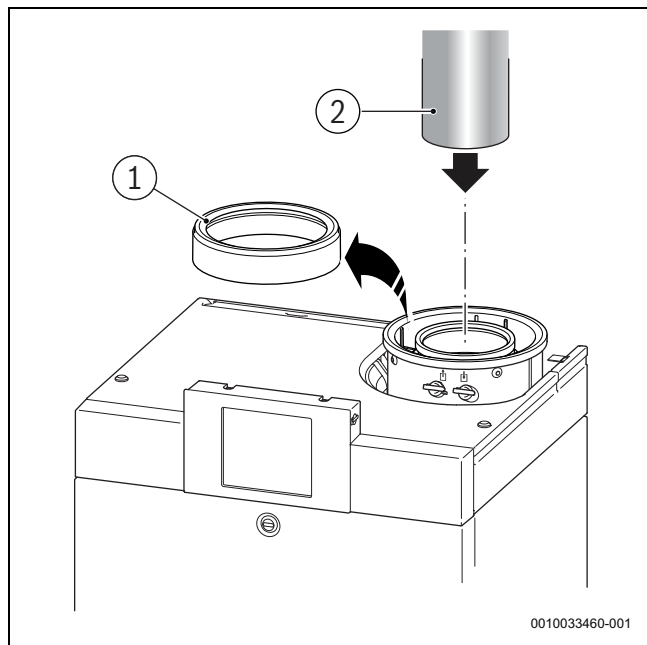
Collegamento a tubo singolo (dipendente dall'aria del locale)
